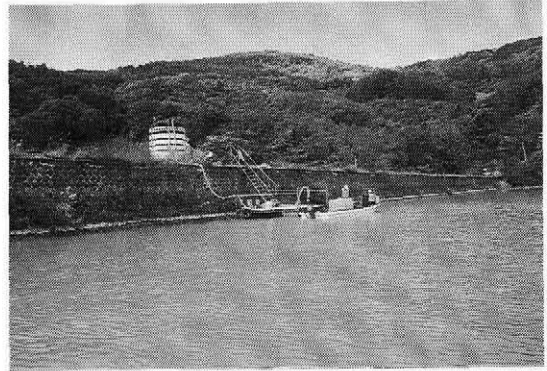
仮設備 (PAC貯蔵タンク, 浮棧橋)
